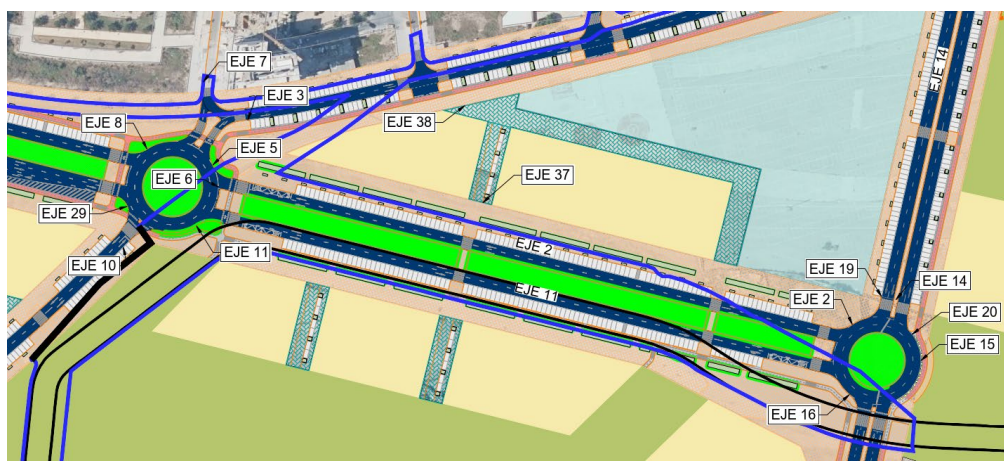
Planta aprovechamiento de aglomerado Ejes 2 y 11
